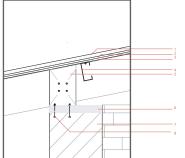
Corte por fachada Fuente: Elaboración propia 2023.
